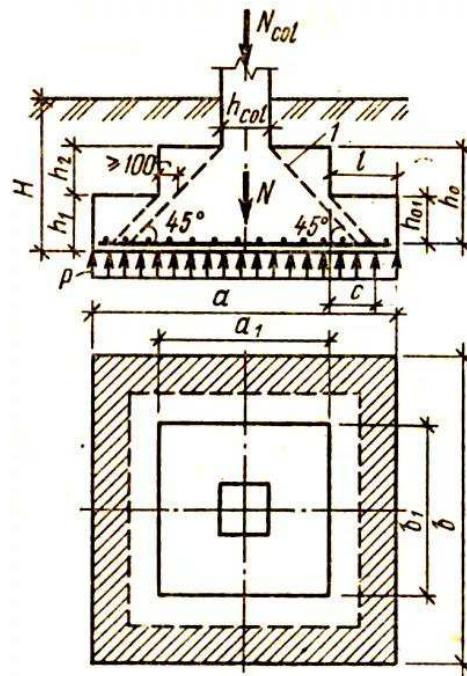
Расчетная схема фундамента колонны на продавливание.
